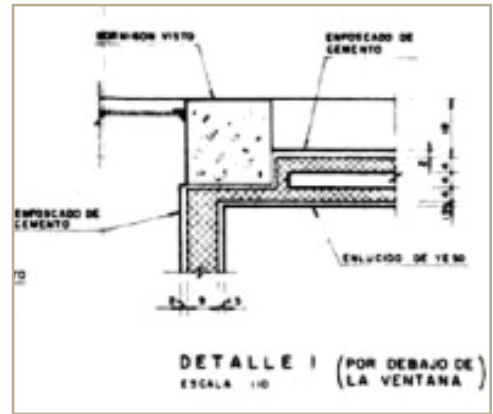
Detalle planta Muro de Cerramiento 1 y Partición 1
